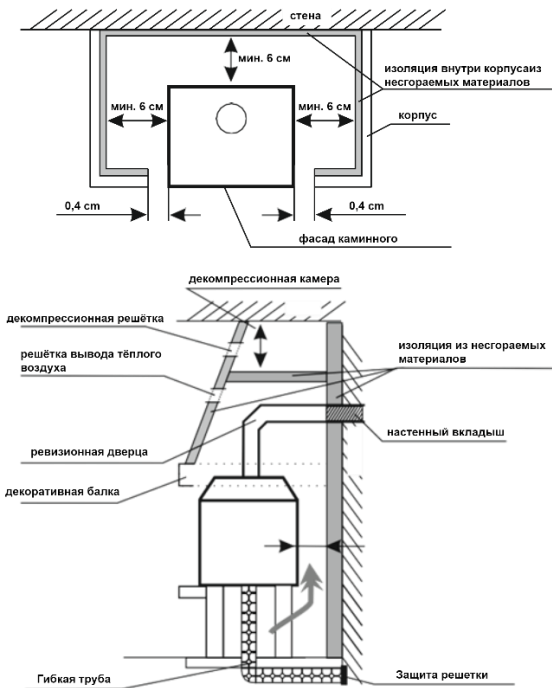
Примерный способ инсталляции каминных вкладышей - вид сверху и сбоку
